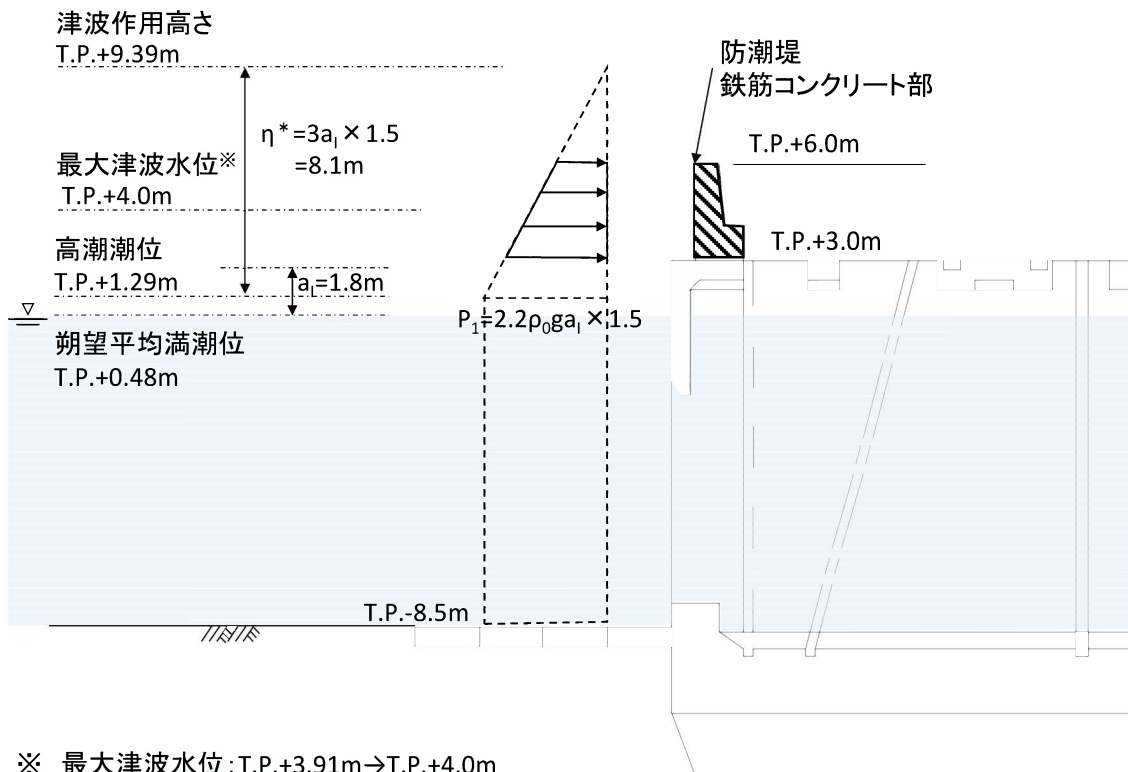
鉄筋コンクリート部の断面図及び津波荷重の作用イメージ
